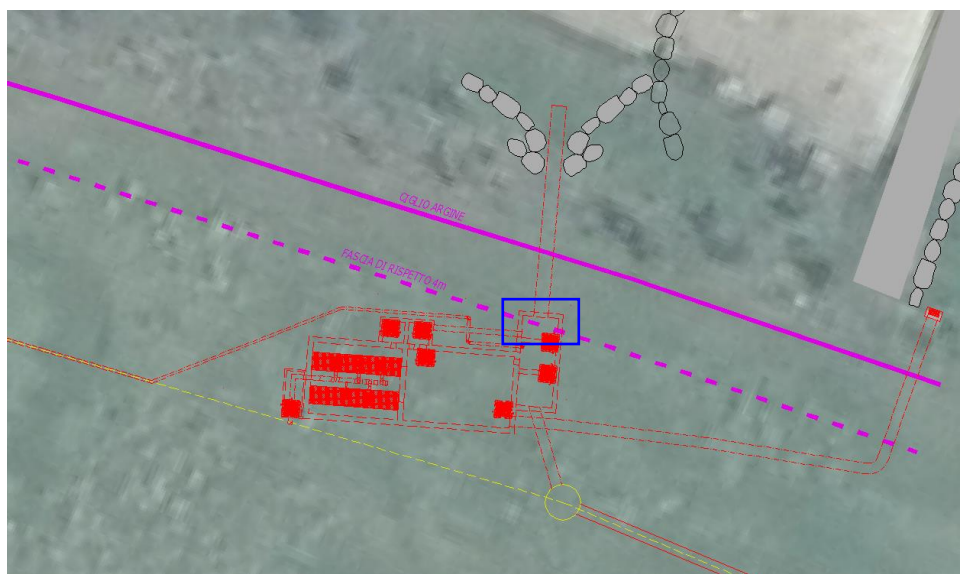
Planimetria delle opere con indicazione della fascia di rispetto di 4 metri dal corso d'acqua
